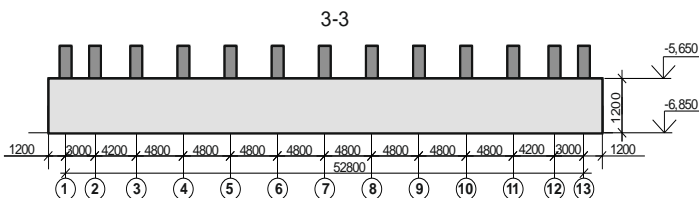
Конструктивное решение плитного фундамента, вариант I (сечение 3-3)
